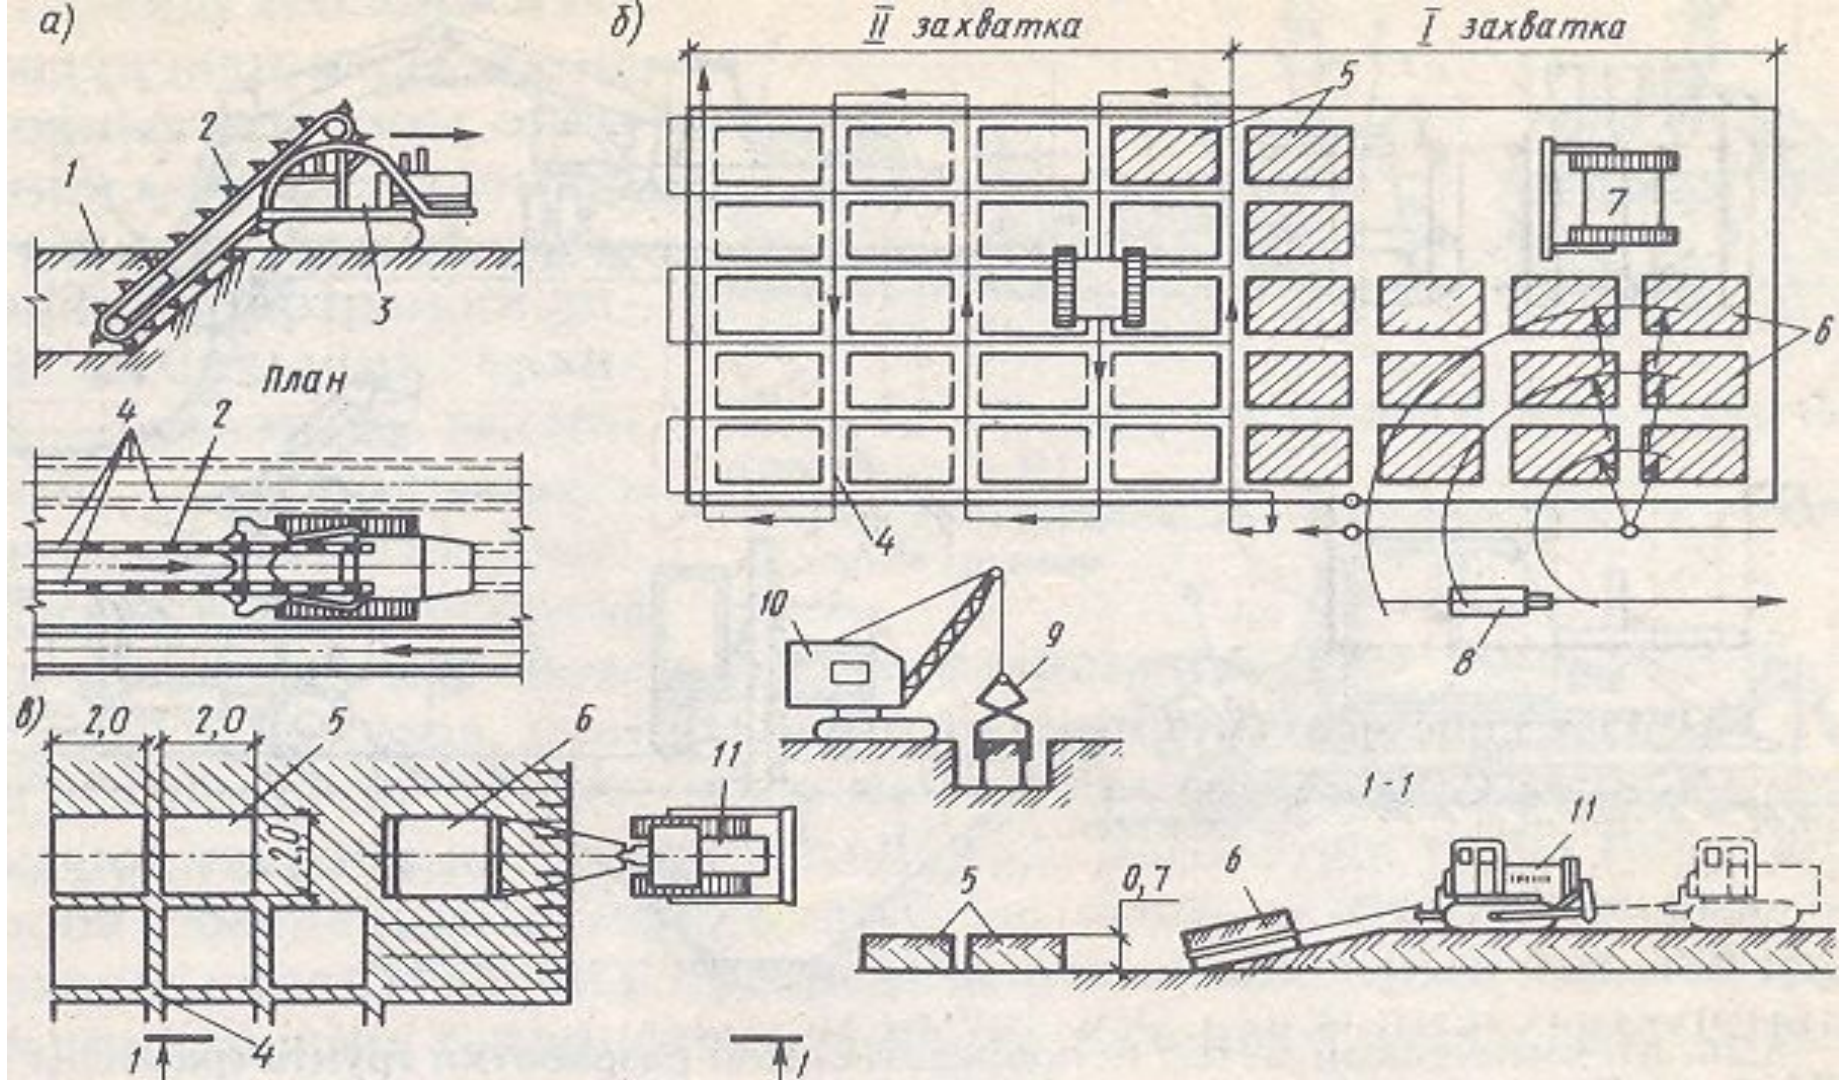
Схема блочной разработки грунта (размеры в м): а – нарезка щелей баровой машиной; б – метод разработки котлована с извлечением блоков из забоя строительным краном; в – то же, с извлечением блоков трактором; 1 – мерзлый слой грунта; 2 – режущие цепи (бары); 3 – экскаватор; 4 – щели в мерзлом грунте; 5 – нарезанные блоки; 6 – удаляемые блоки; 7 – стоянка крана; 8 – транспортное средство; 9 – клещевой захват; 10 – строительный кран; 11 – трактор
